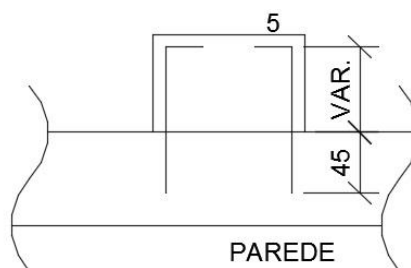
Esquema em planta mostrando os grampos de solidarização entre parede e pilar de reforço
